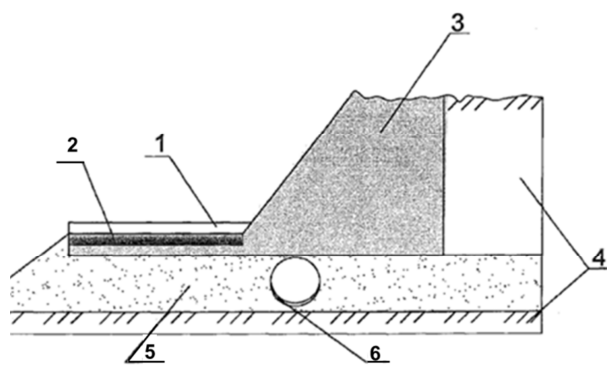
Конструкция подпорной стенки: 1 – верхнее дорожное покрытие, 2 – конструкционный пенобетон, 3 – теплоизоляционный пенобетон, 4 – грунт, 5 – песок, 6 – трубопровод
